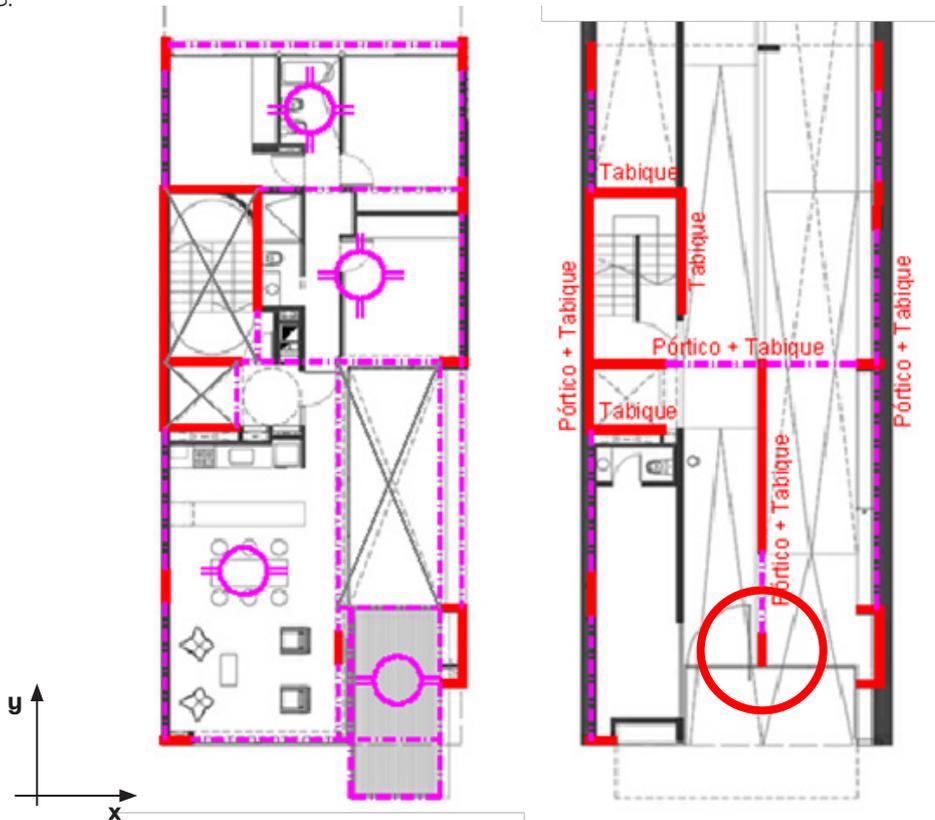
Esquema estructural losa nivel 3 y 5 y Estructura portante de planta baja y direcciones de análisis. Fuente: Elaboración propia
